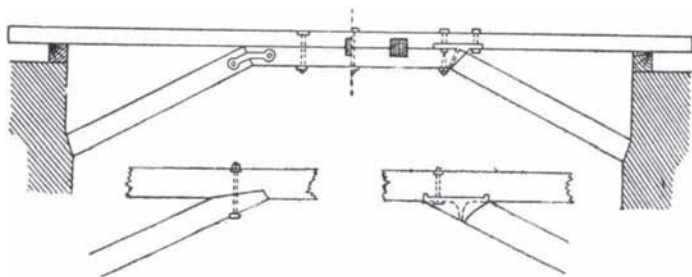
VIGA REFORZADA POR UNA SOPANDA Y DOS JABALCONES
